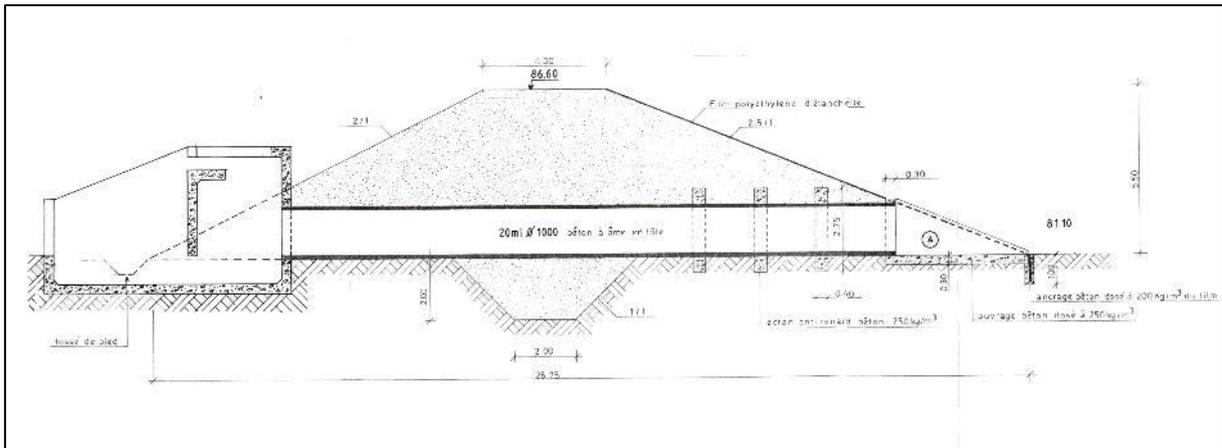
Profil en travers de l'ouvrage de La Roche (source : plans de construction)
